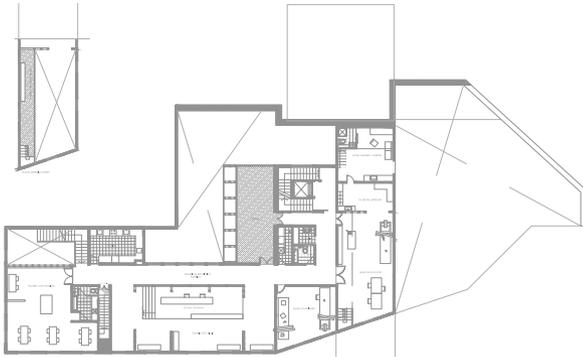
Planta 2do nivel, Centro Extensión GAL_212
